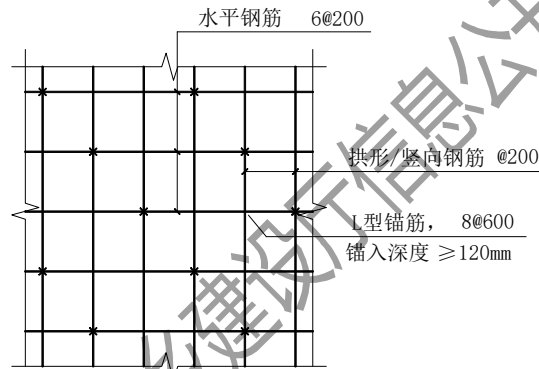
配筋高延性混凝土面层的钢筋配置示意图
